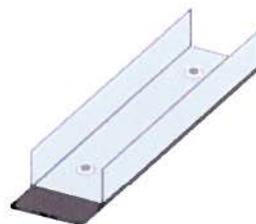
Aplicação de banda acústica entre o perfil raia e o suporte.
